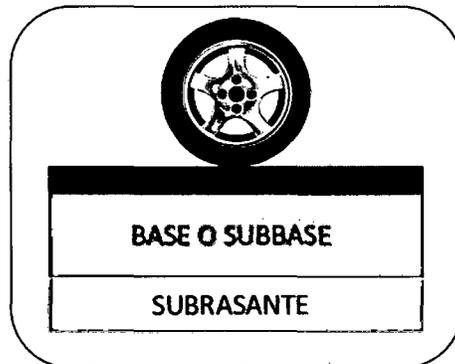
Esquema de paquete estructural para Pavimento rígido
